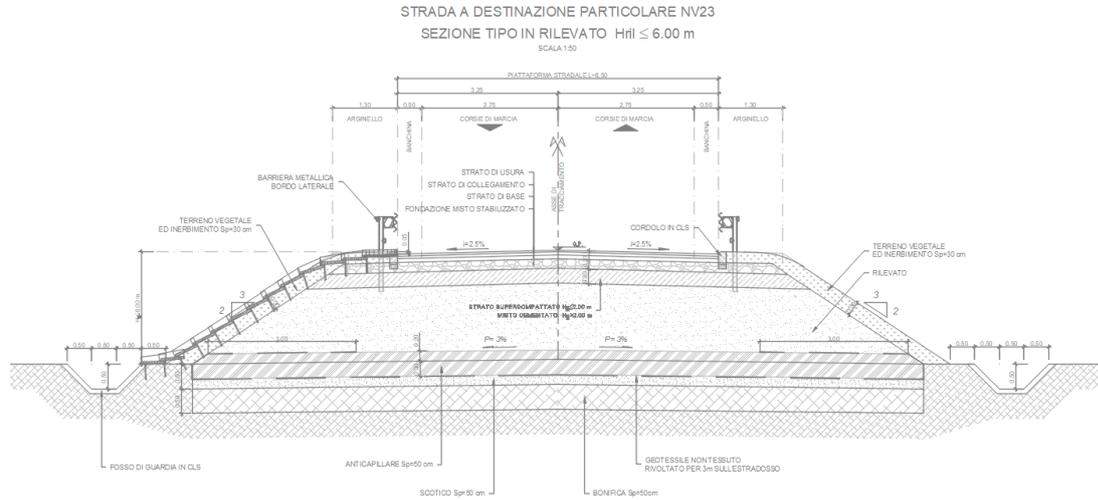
Sezione tipo in rilevato per NV23-NV24
